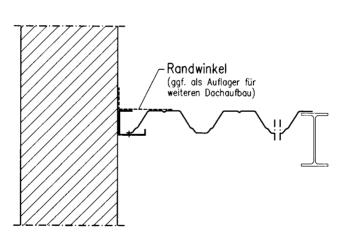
Auflagerträger (Stahl, Holz, Beton) Abstand der Verbindungselemente e_R ≤ 666 mm
